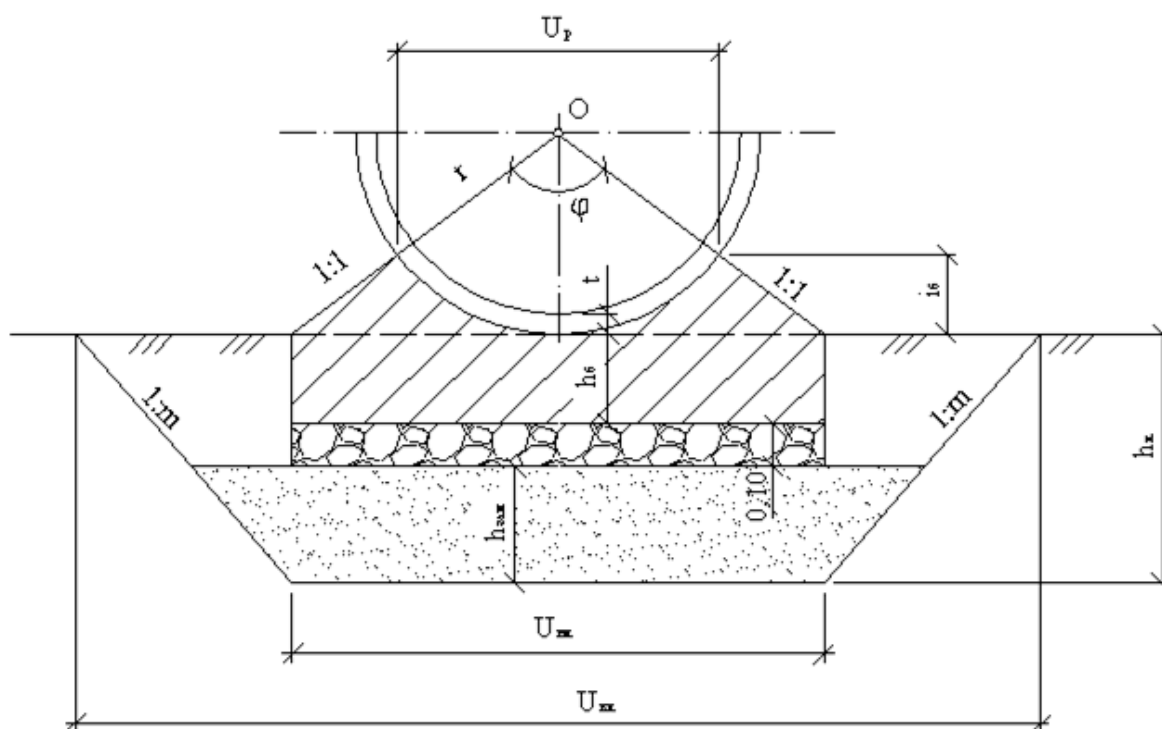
Поперечное сечение фундаментной трубы при замене грунта под основание
